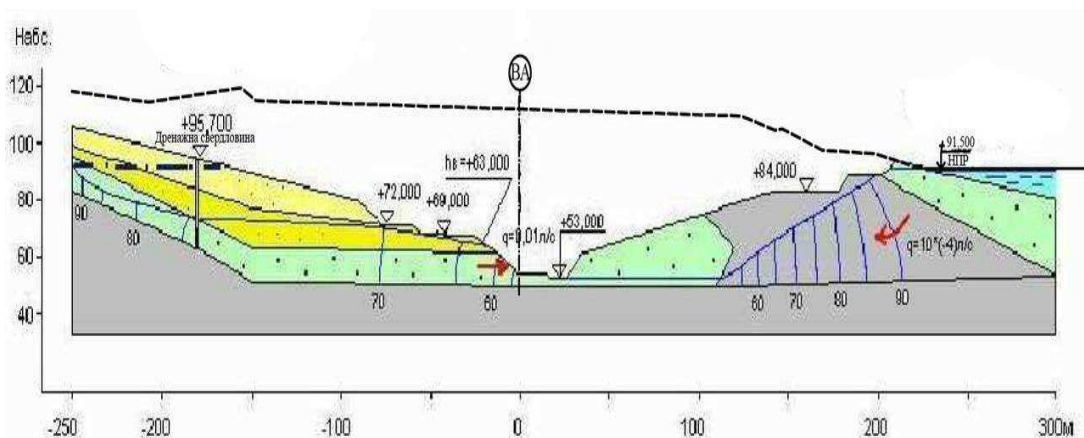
Схема осушення котловану для влаштування будівлі ГАЕС
